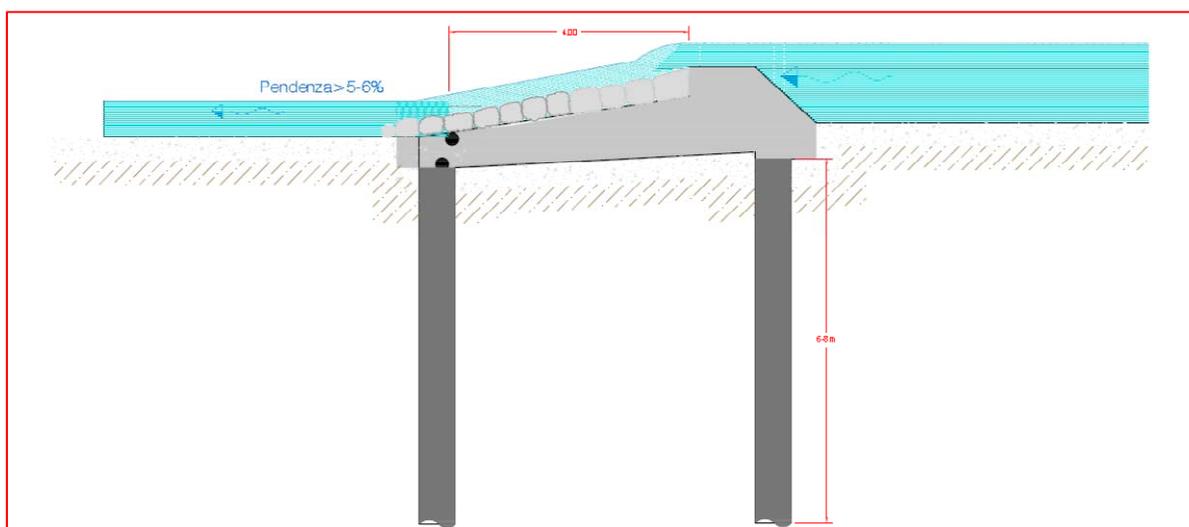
a Sfiore - Sezione trasversale B-B
